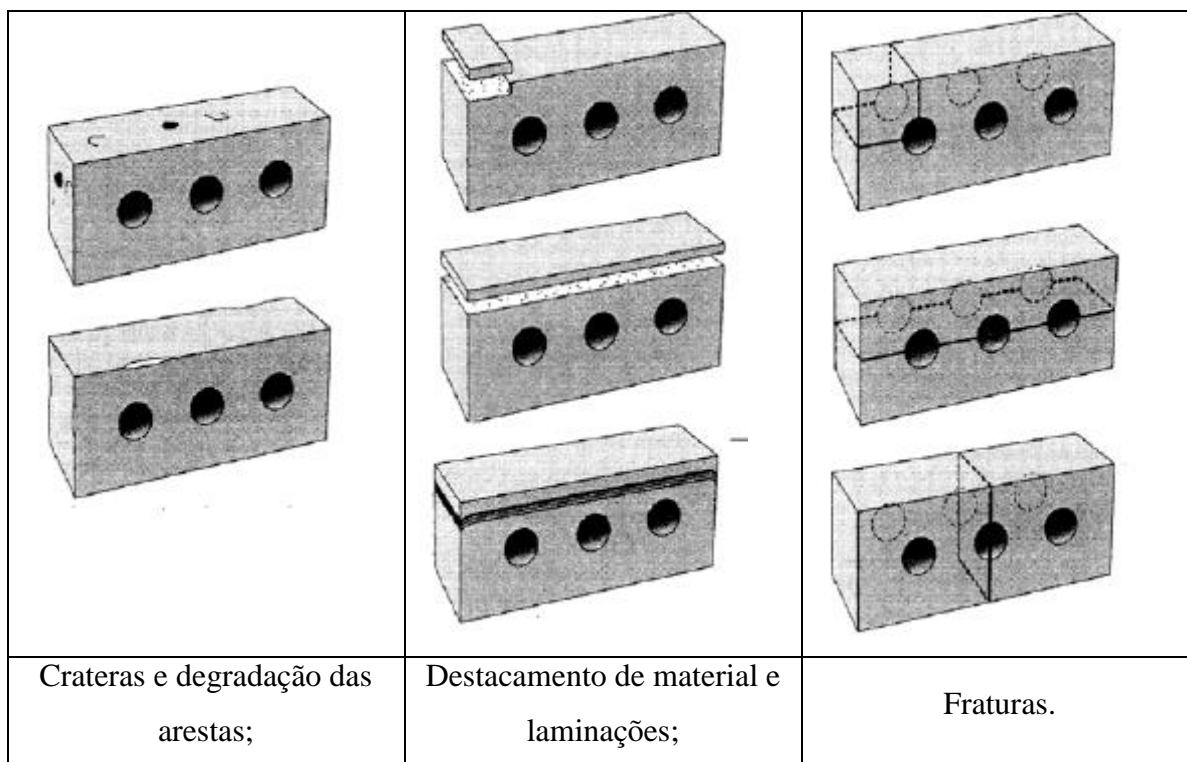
Tipos de degradação e fissuração do tijolo devido à ação do gelo (Silva, 1998)
